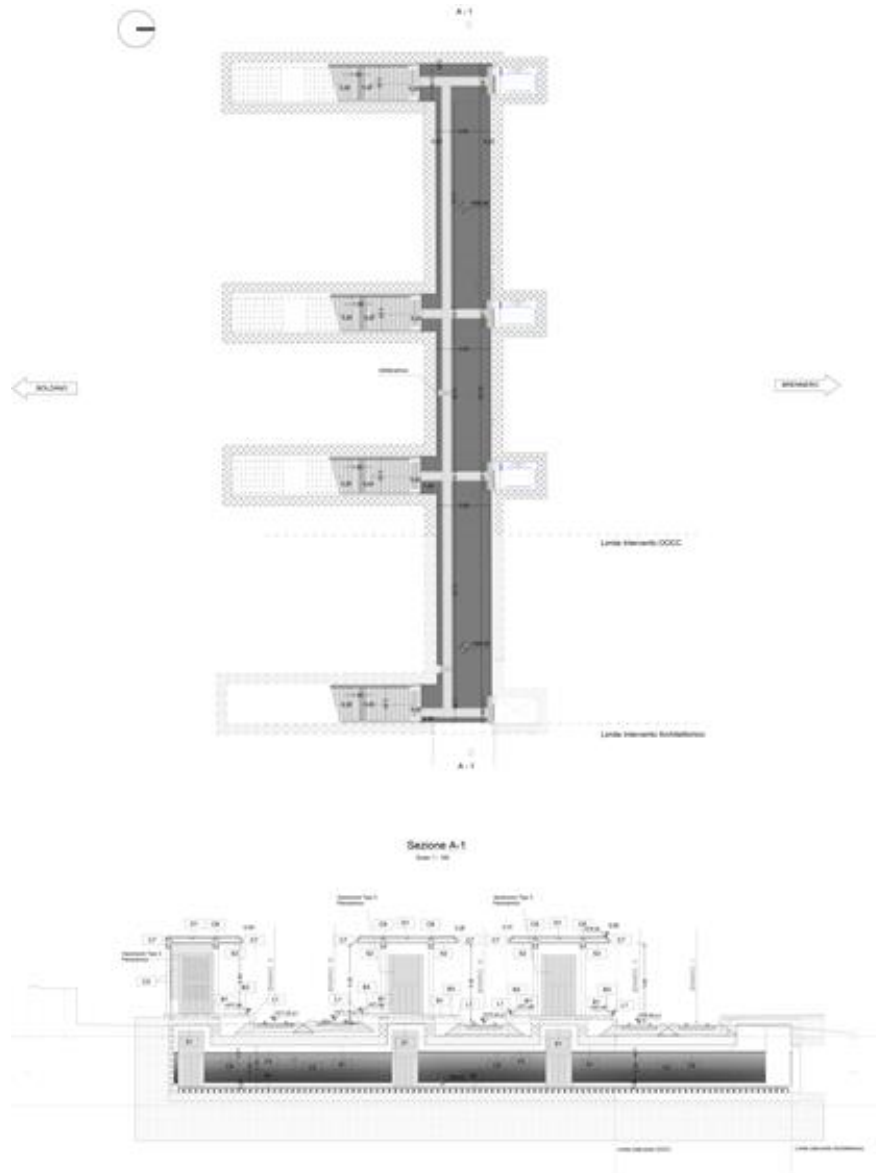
Nuovo sottopasso pianta e sezione longitudinale
